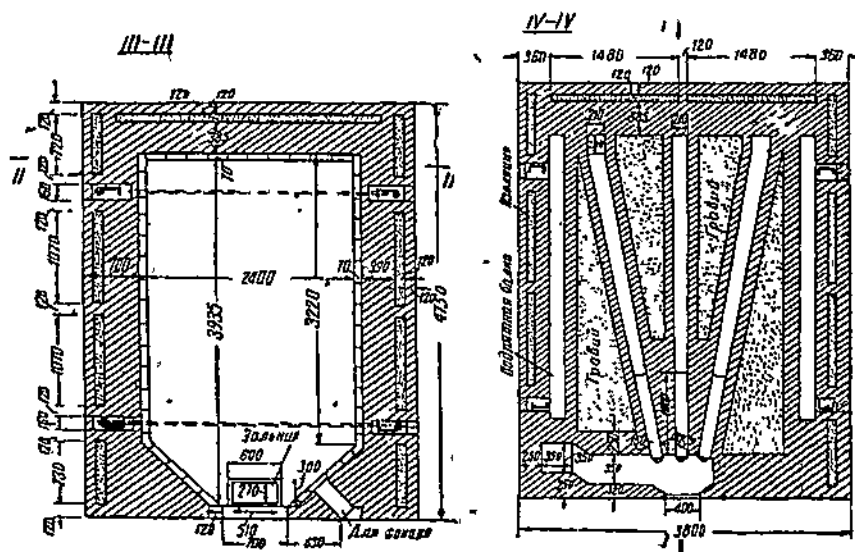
Жаровая одноярусная печь площадью пола 8 м² — планы.
